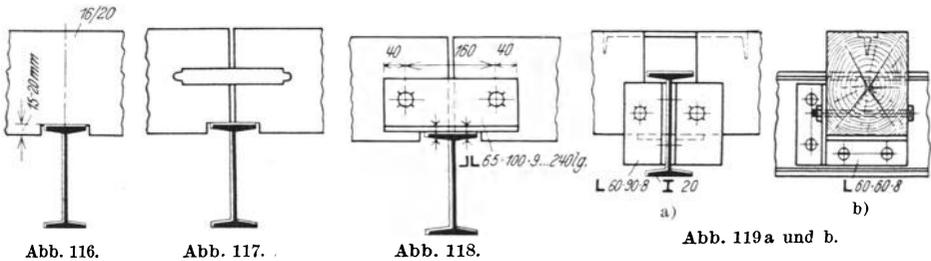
bis 119. Auflagerung der Holzbalken auf Stahlunterzügen.
